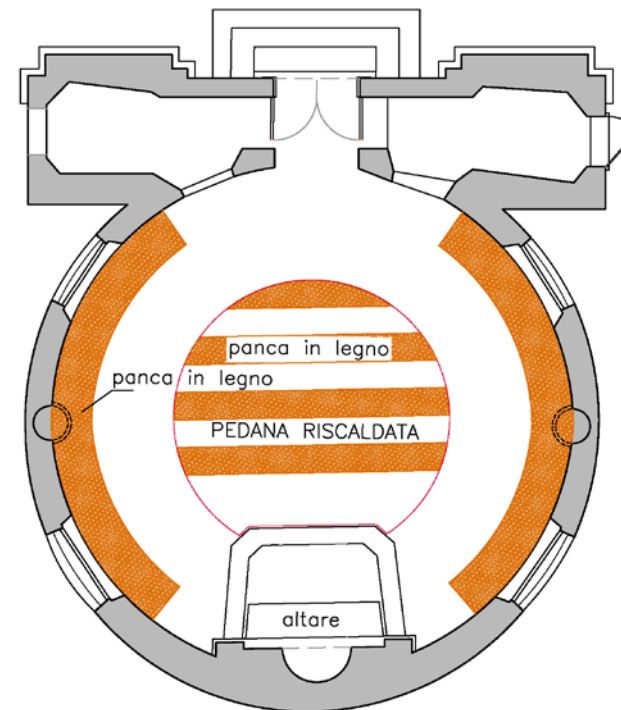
Pianta della cappella post restauro e nuova progettazione di sedute in legno ed elementi riscaldanti
